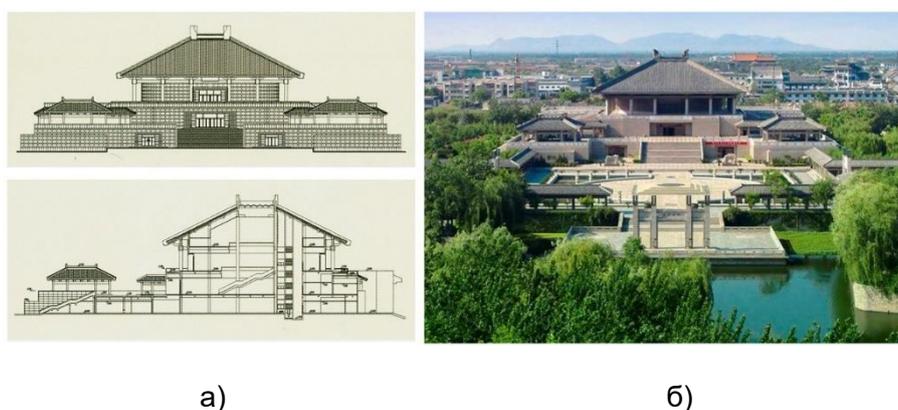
Главный корпус Исследовательского института Конфуция: а) фасад и разрез; б) общий вид
